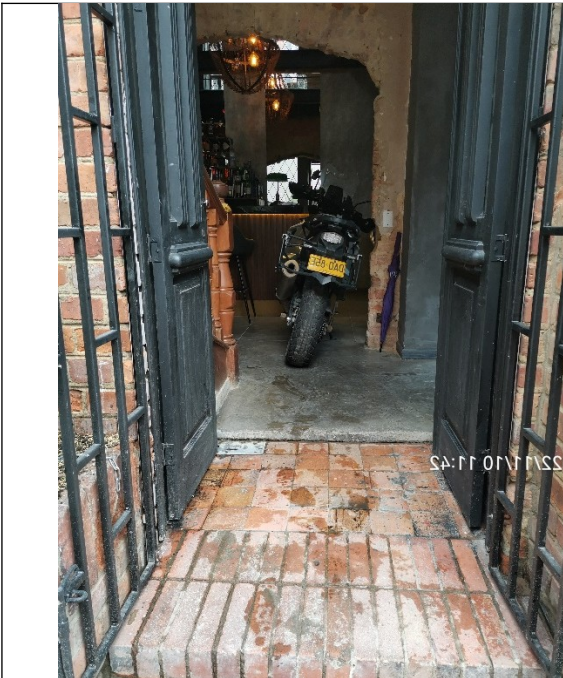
Fachada principal del inmueble sobre la Calle 67
